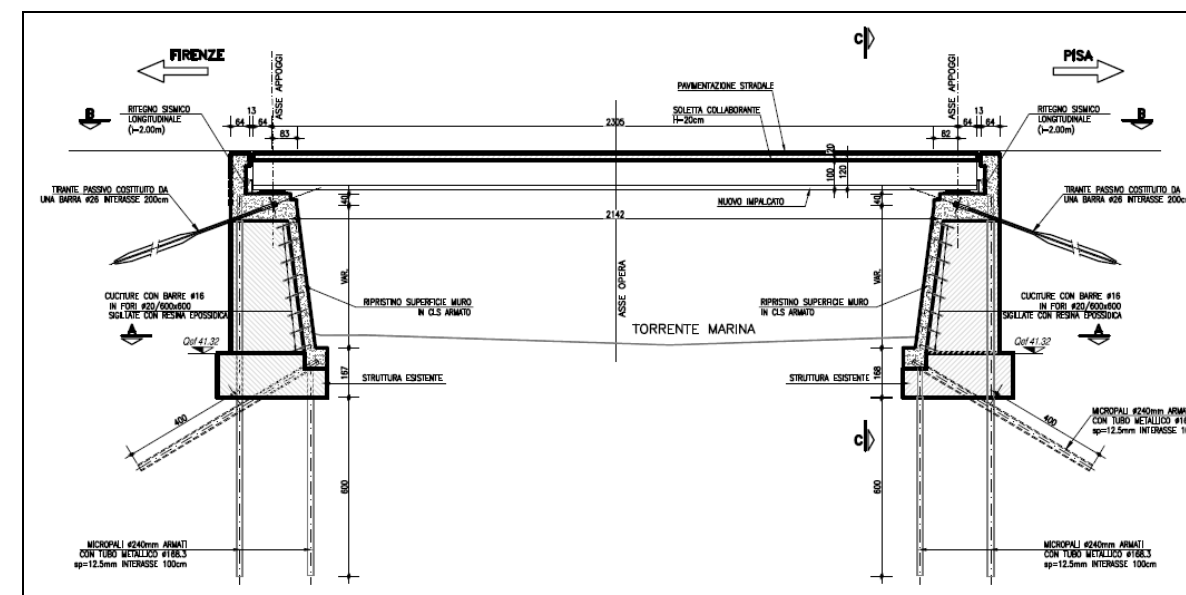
Ponte sul T. Marina. Sezione longitudinale
